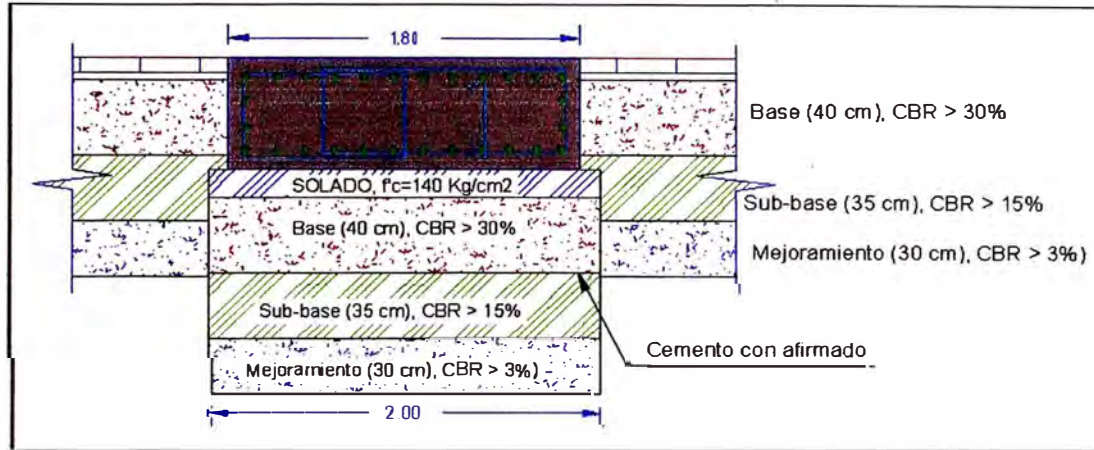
Detalle de la cimentación de las vigas RTG.
